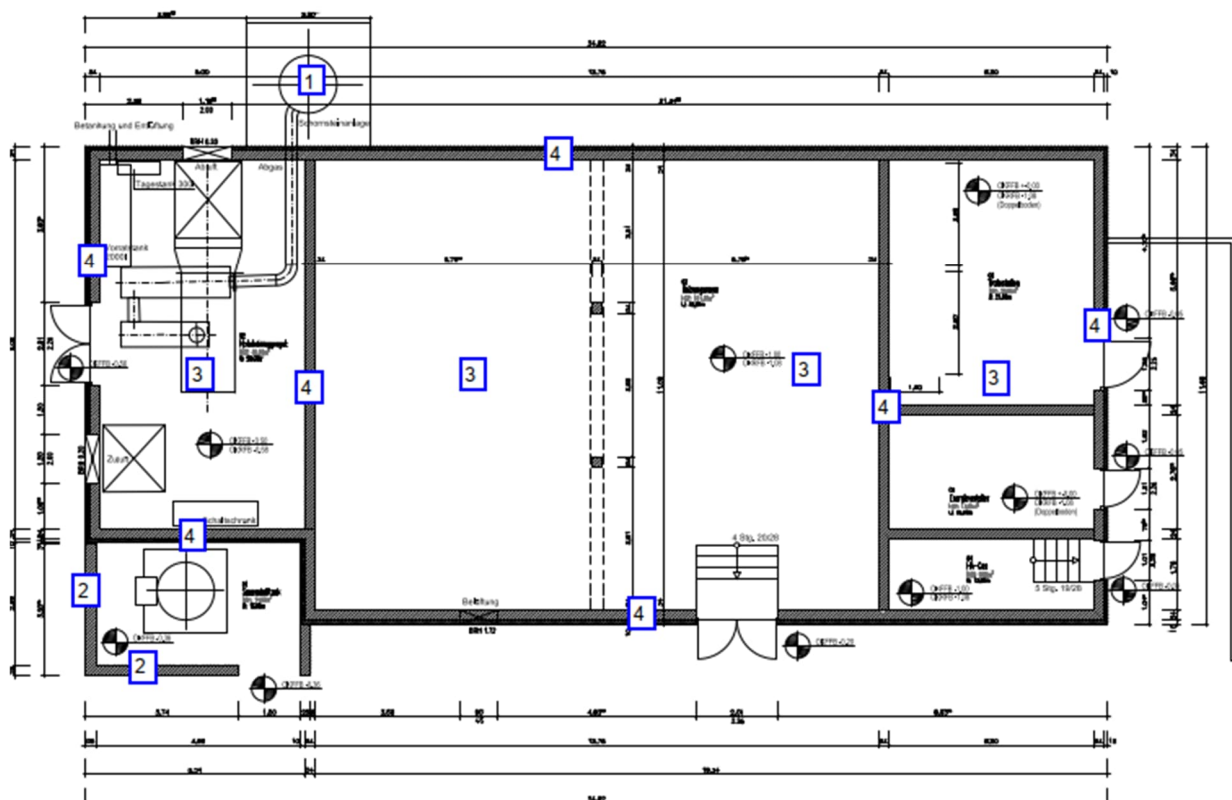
Auszug Ausführungsplan Grundriss KG von der Firma B+K vom 30.05.2011
